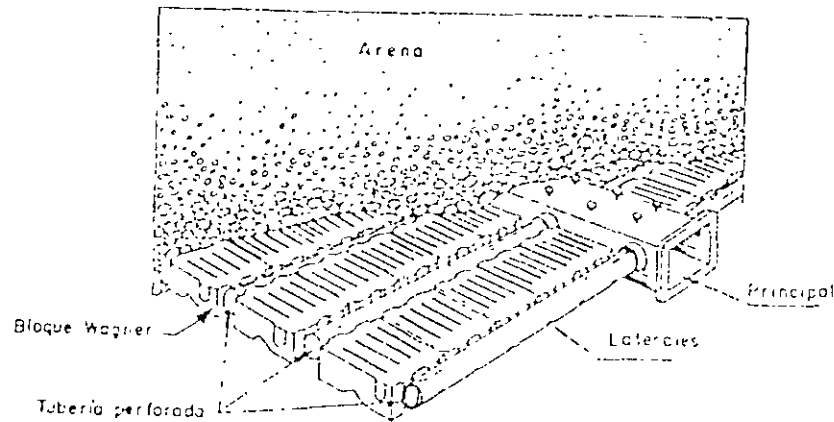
Fondo de tubería con bloques Wagner (Cortesía de Infilco Inc.)
